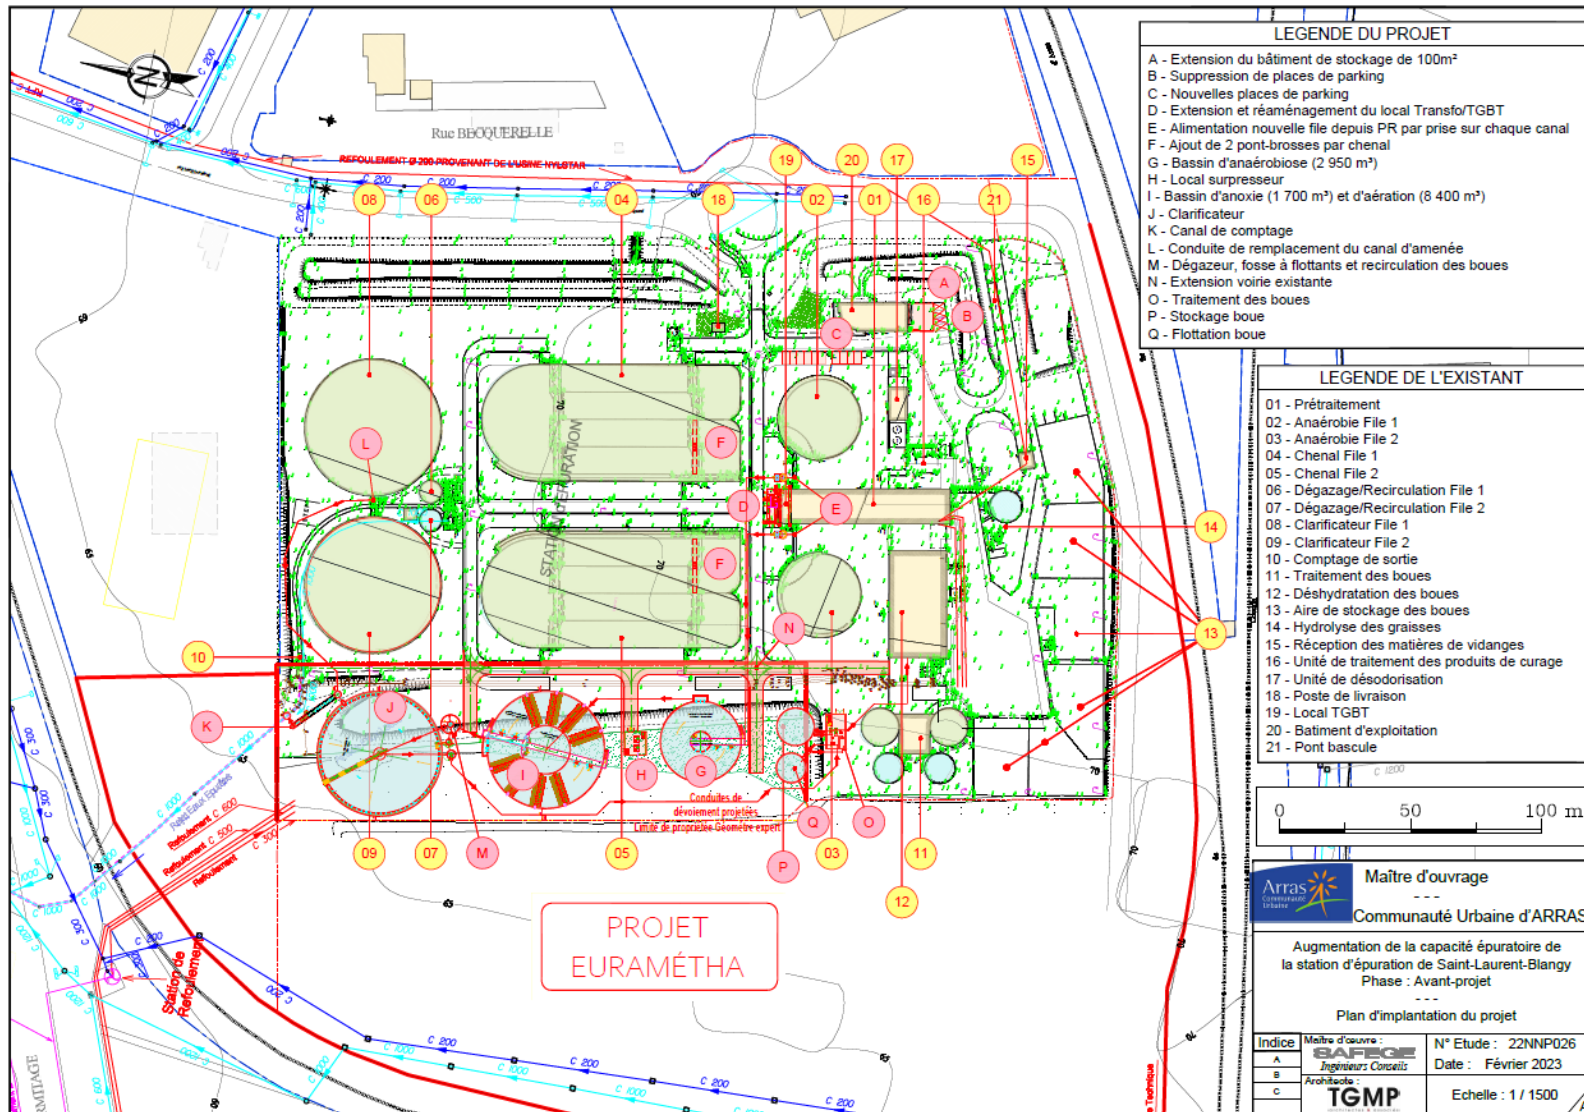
Plan d'implantation du projet (Source : Safège, AVP, 02/2023)
